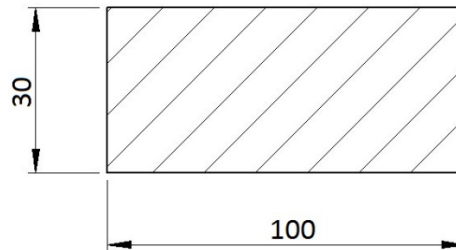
Sección rectangular maciza de una viga transversal (Fuente: propia)
